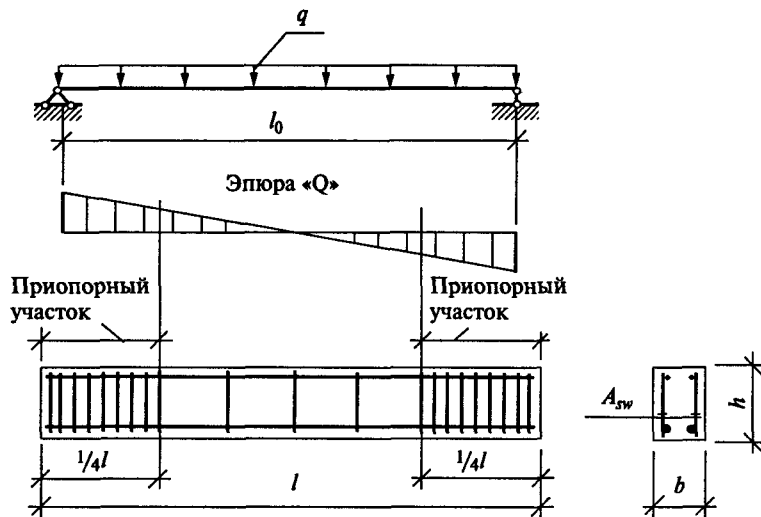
Расстановка поперечных стержней в каркасе балки (балка несколько длиннее расчетной схемы); площадь сечения поперечных стержней в сечении балки —  $A_{sw}$
